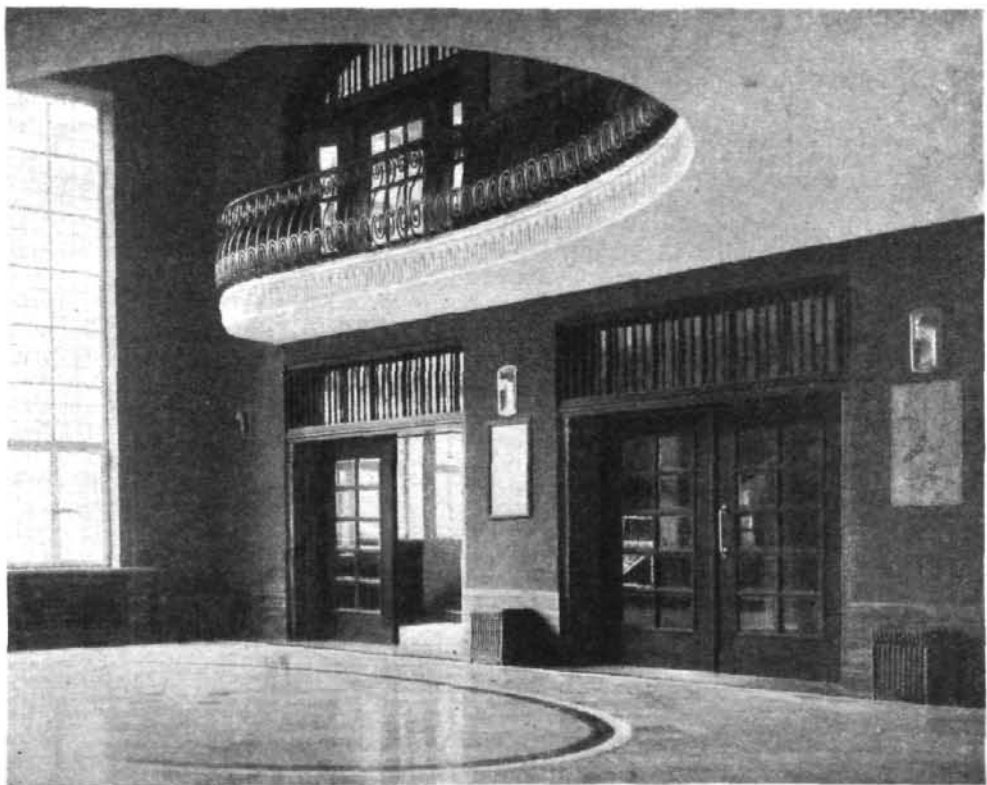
Durchgehende Halle im Hauptgeschoß und ersten Stock.
